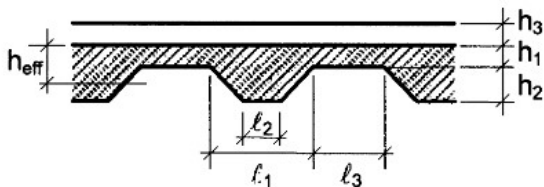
Dalle mixte avec plaques trapézoïdales en acier
